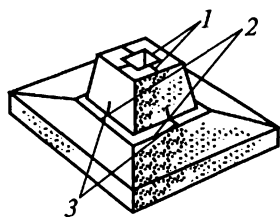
Совмещение рисков при монтаже фундамента под колонну:
